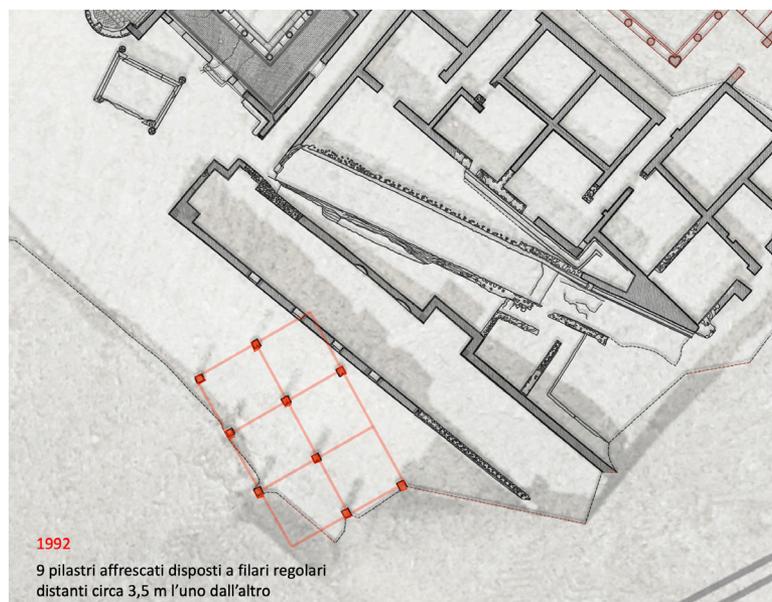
Individuazione del modulo che definisce la posizione dei pilastri nell'amb 73.
